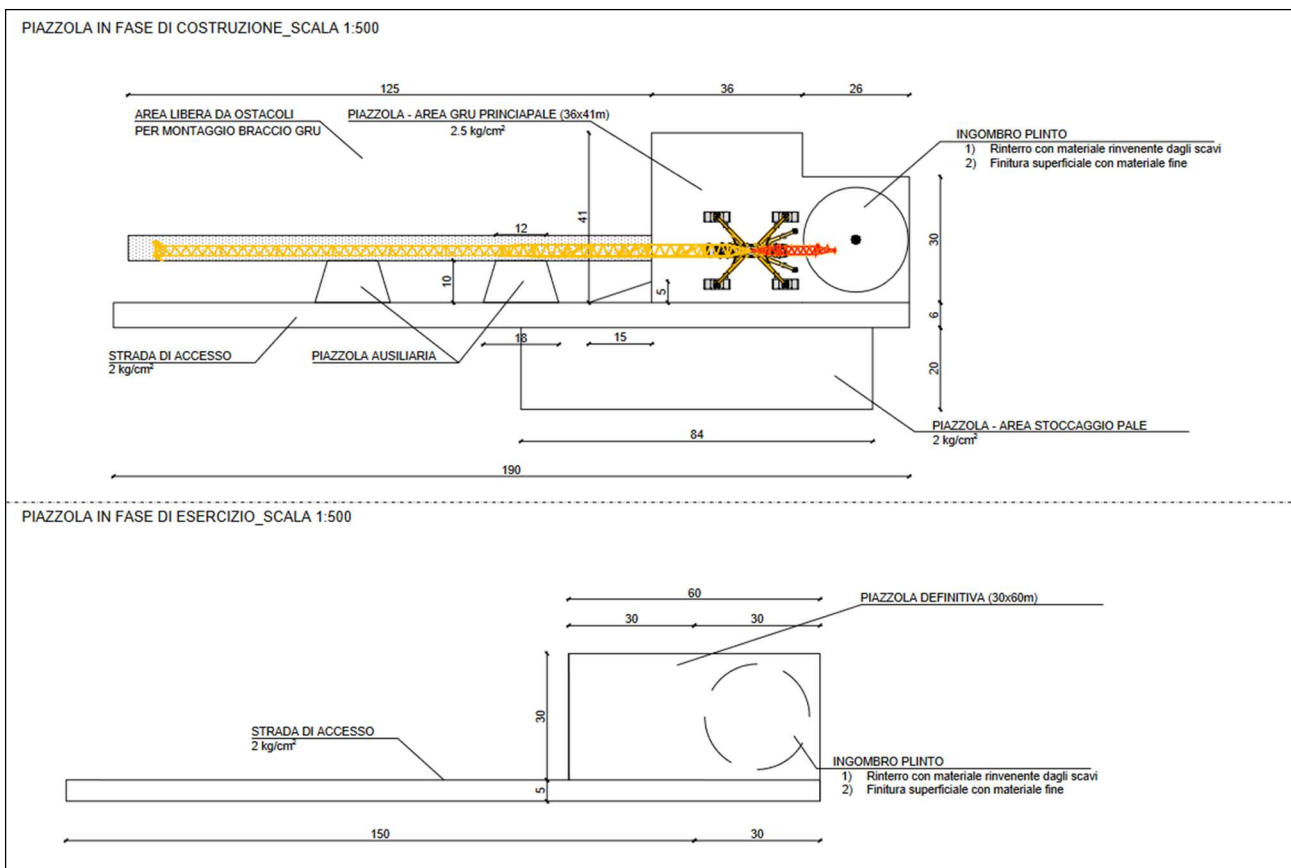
Planimetria piazzola tipo per la fase di installazione e fase di esercizio e manutenzione
